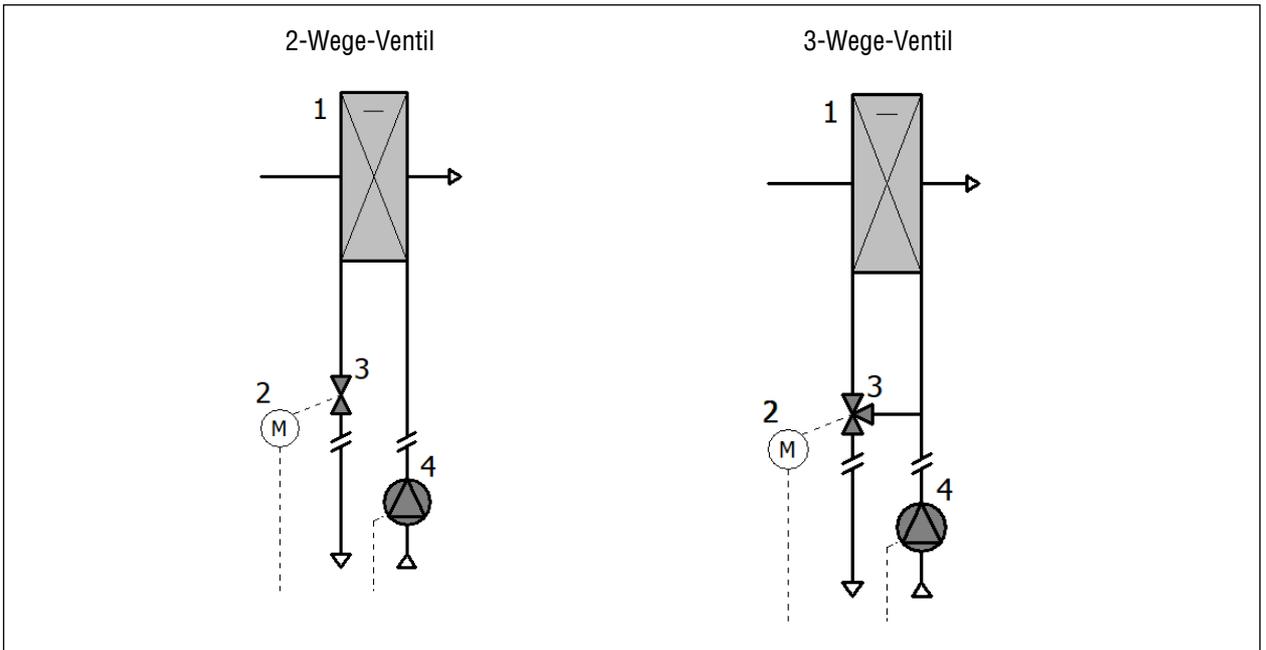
Anschlussausführungen mit 2-Wege-Ventil und 3-Wege-Ventil
